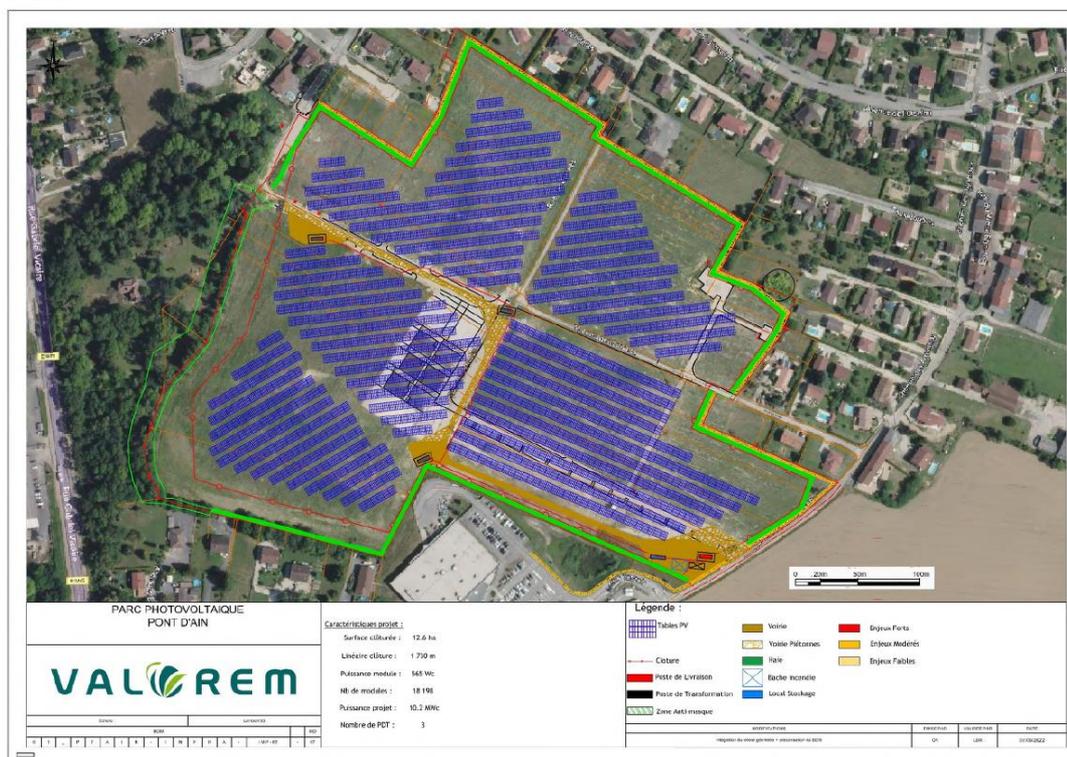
Plan d'implantation – Projet de Pont d'Ain (source : SPV Pont d'Ain Energies)
